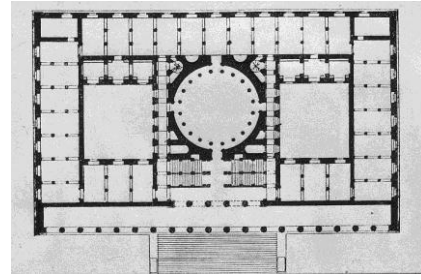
Altes Museum, 1823-30. Planta baixa. Fonte: University of Pittsburg.
